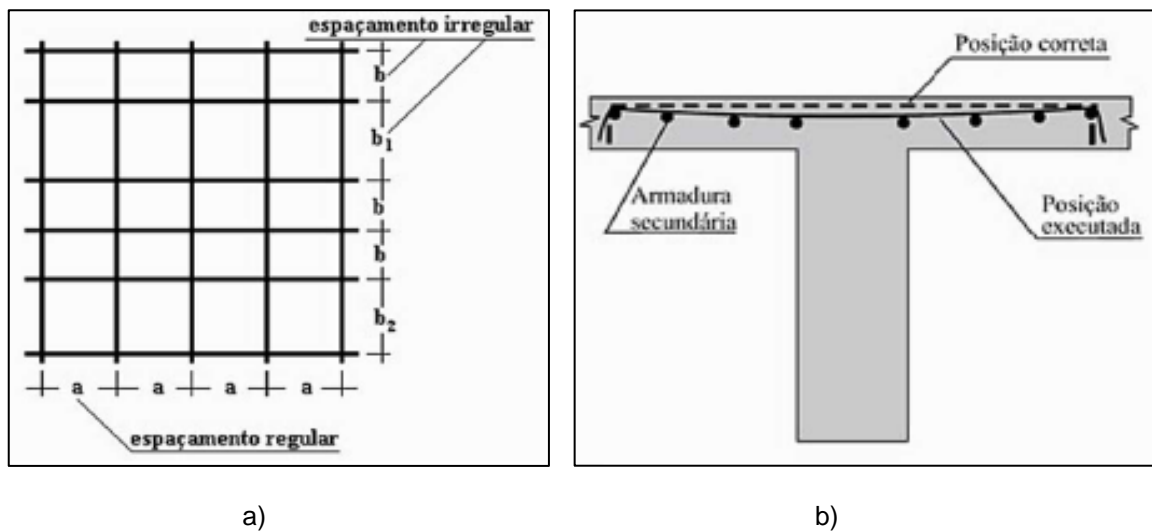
a) Espaçamento irregular em armadura de laje; b) Armadura negativa da laje fora de posição. Fonte: (SOUZA & RIPPER, 1998).
